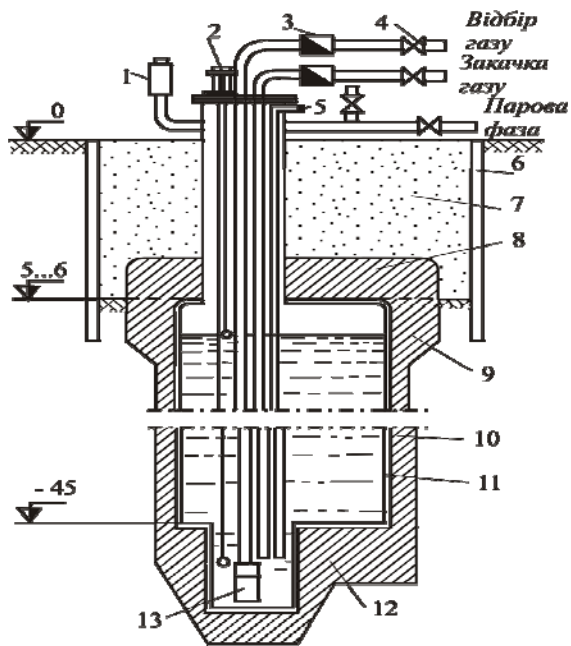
Вертикальна ємність з залізобетонним кріпленням та металоізоляцією: 1 – клапан для вентиляції; 2 – сигналізатор крайнього рівня газу; 3, 4 – трубопровідна арматура; 5 – барботажний патрубок для вимірювання рівня газу; 6 – шпунт; 7 – ґрунтова засипка; 8 – перекриття; 9 – устя; 10 – кріплення; 11 – металоізоляція; 12 – днище; 13 – заглибний насос
